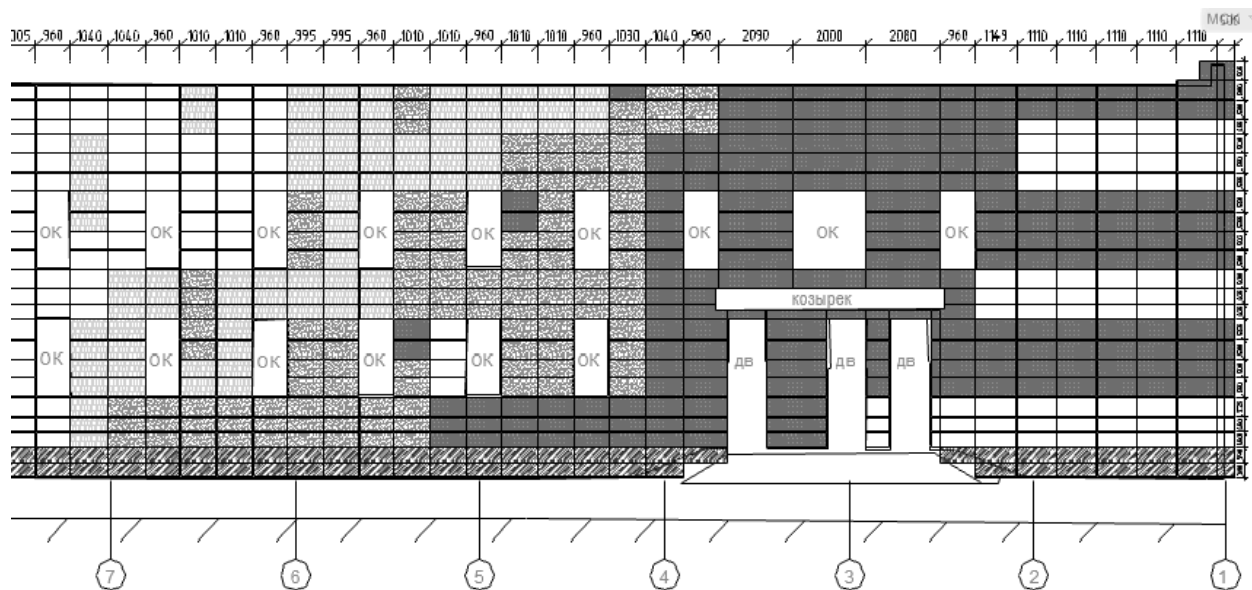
Раскладка кассет на фасаде в осях 8-1.
